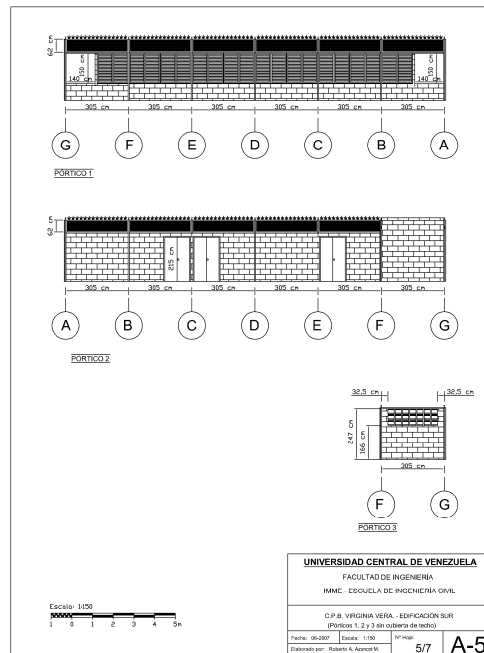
Plano A5: Plano Arquitectónico de los pórticos 1, 2 y 3 sin techo
